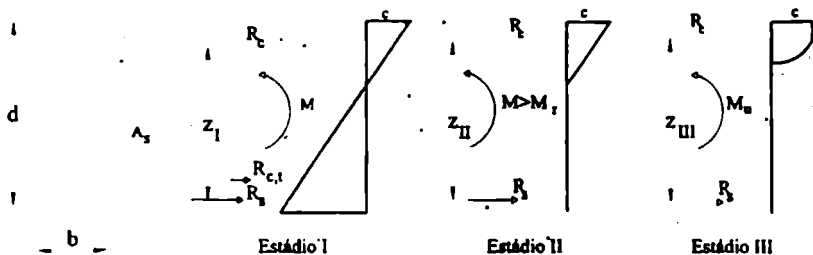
Comportamento da seção transversal de uma viga de concreto armado na flexão normal simples.
